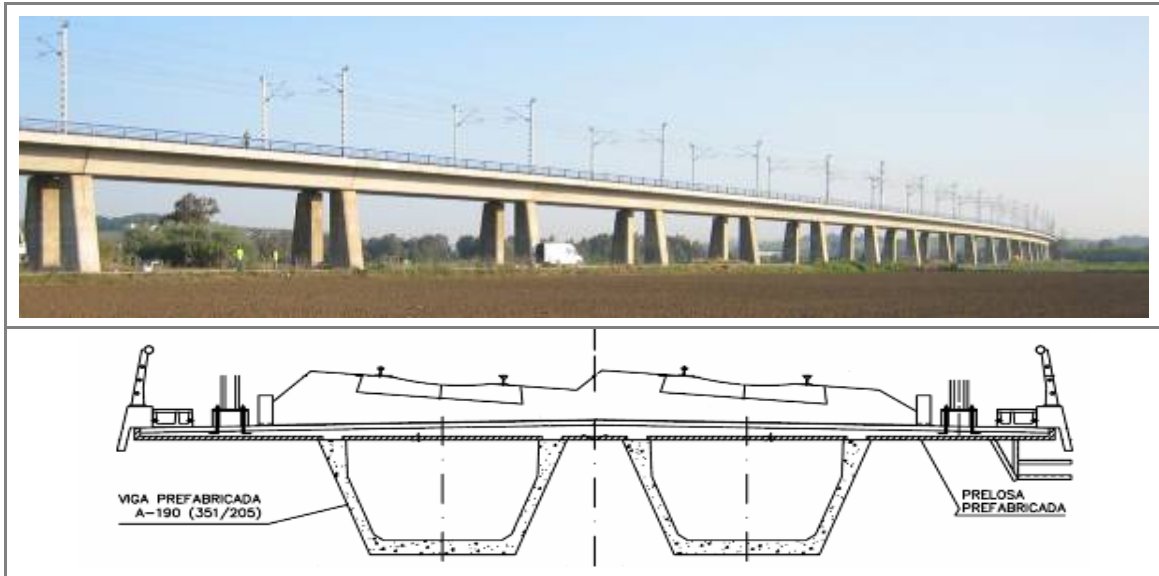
Vista longitudinal del viaducto así como sección transversal del tablero del mismo.
